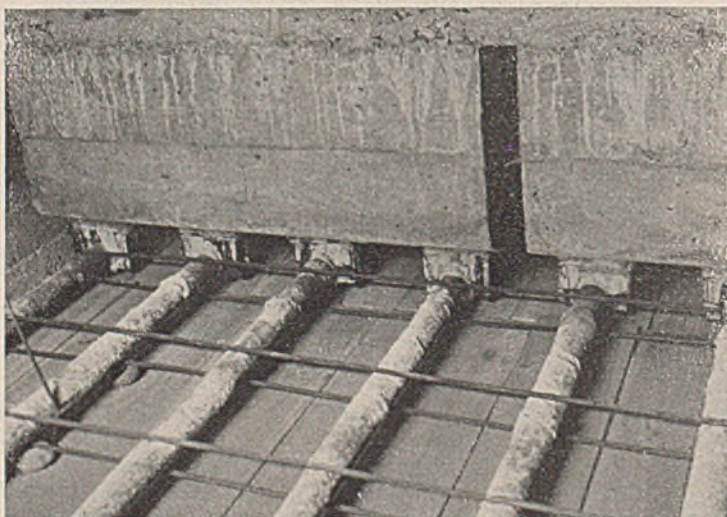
Zugseisen am Pendel vor dem Einbetonieren.
